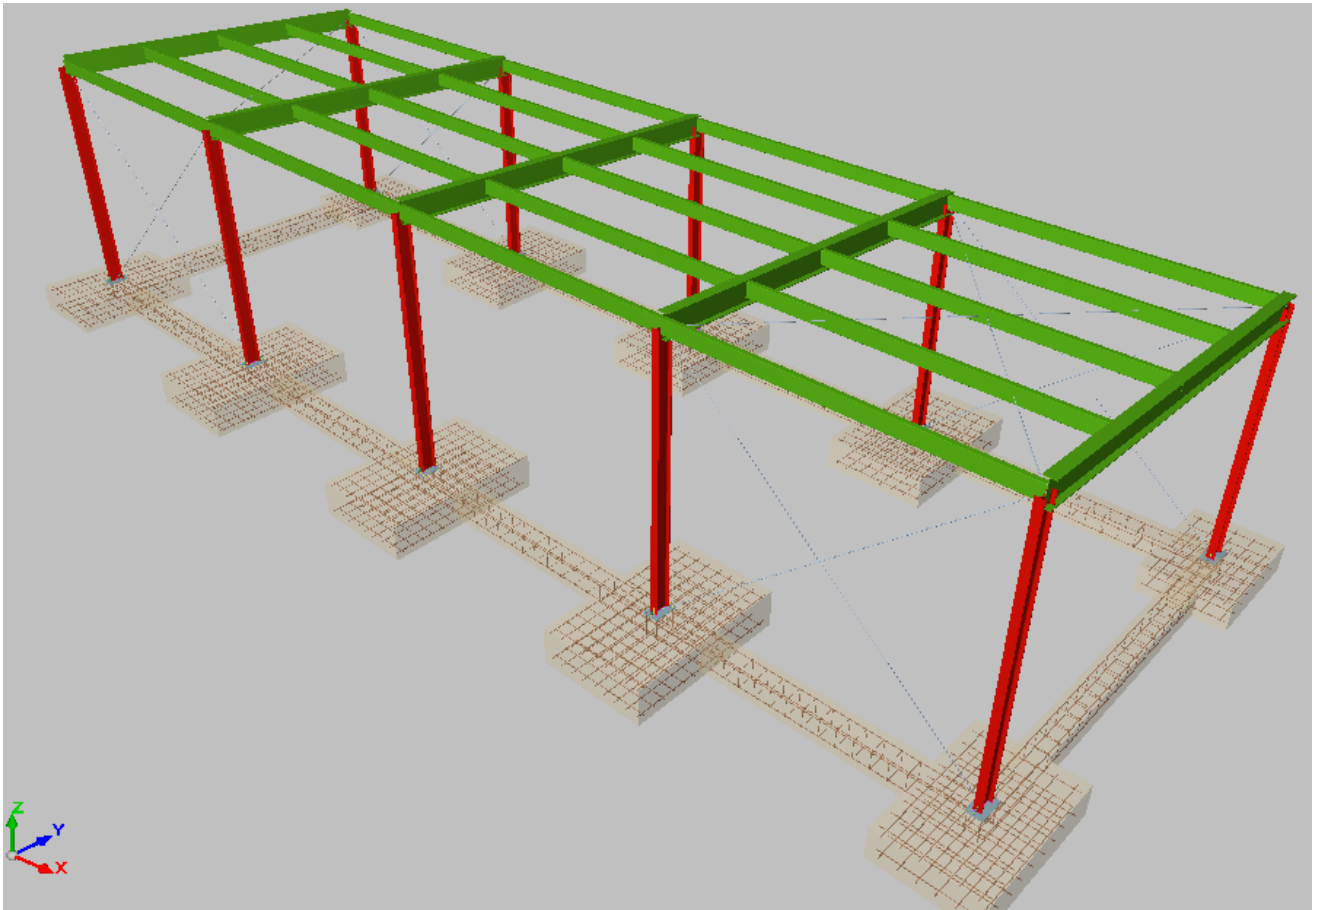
Imagen en 3D de la estructura metálica y las zapatas.
